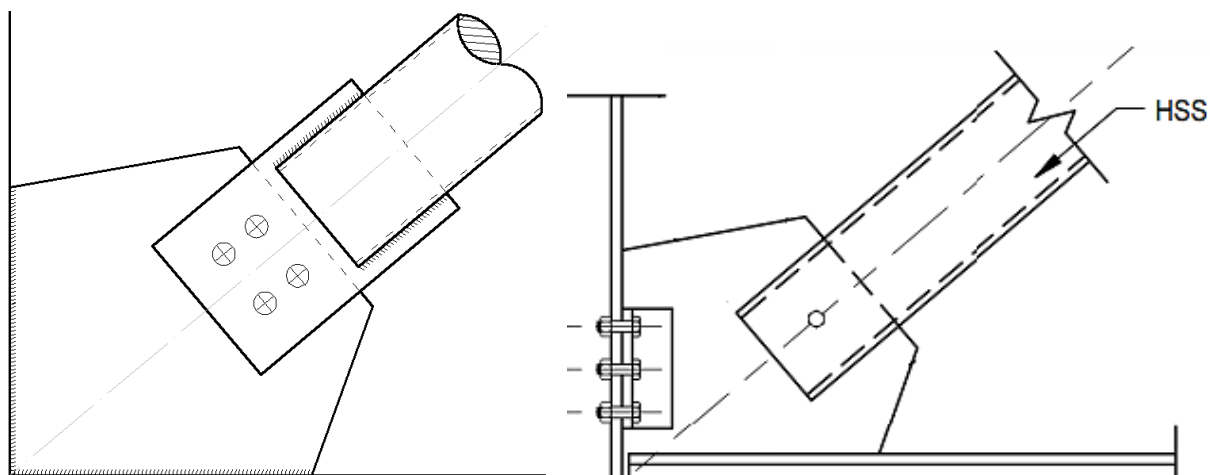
Ligação chapa de gousset-estrutura. a): gousset soldado; b): gousset soldado e aparafusado
